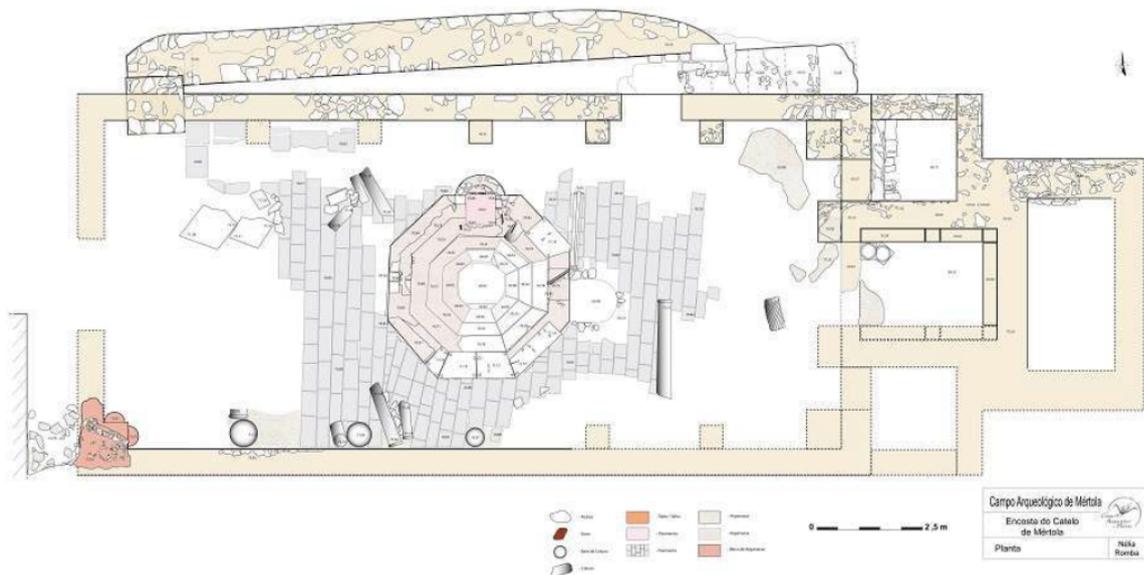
Planta geral das estruturas postas a descoberto na alcáçova de Mértola, Beja. (LOPES, 2015)
